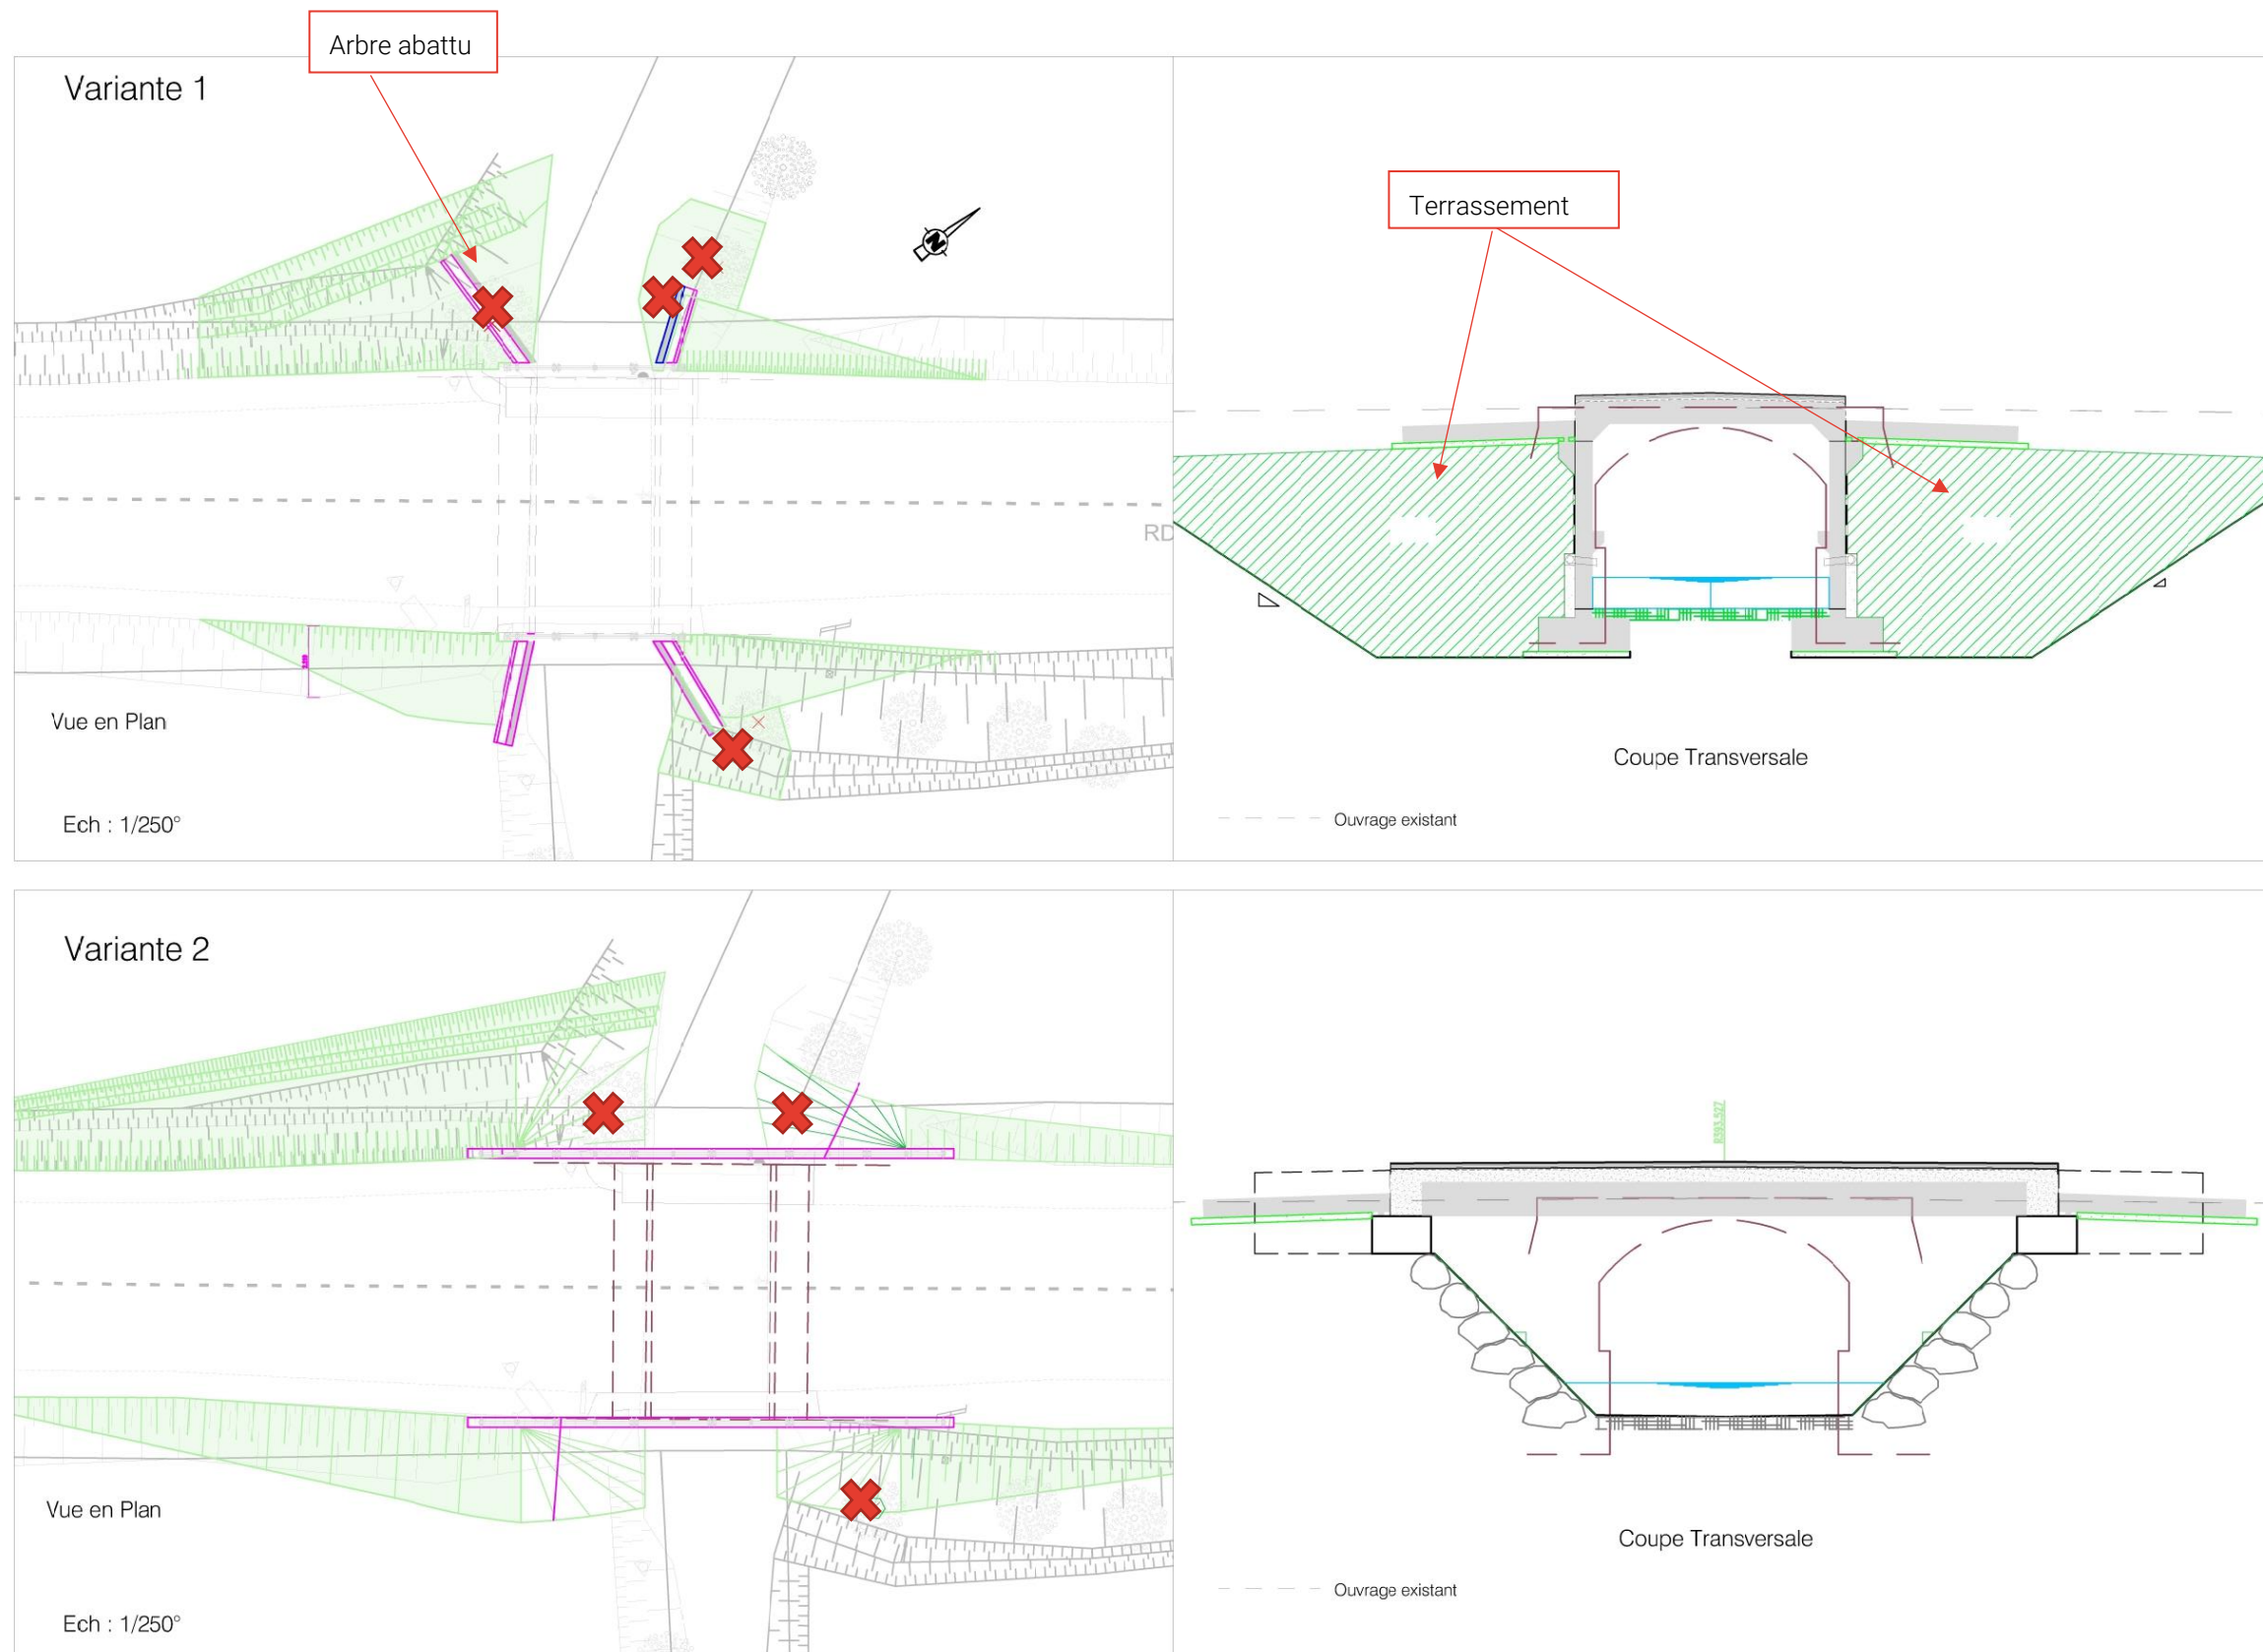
vue en plan et coupe longitudinale de l'hypothèse 1 et 2
